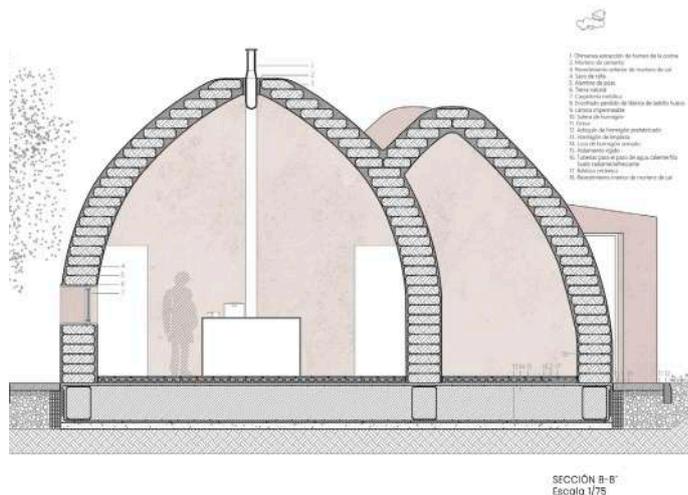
Sección tipo 2 del restaurante. Ver anexo con la documentación del proyecto
